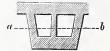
Grundriß nach of. Doppel-Schachtofen.
